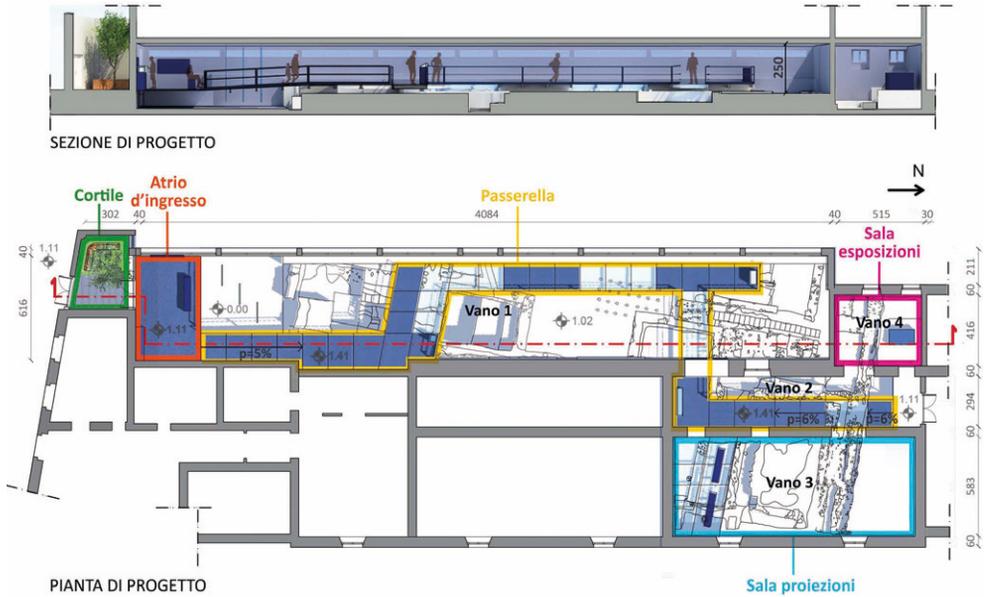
In basso: pianta di progetto con indicate le principali funzioni; in alto: sezione longitudinale.
